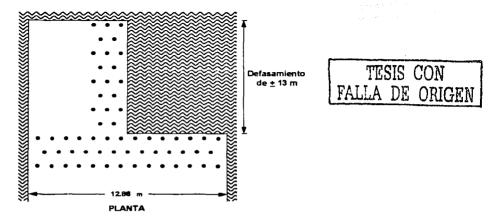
Defasamiento de la sección excavada con respecto a la Sección derecha.
